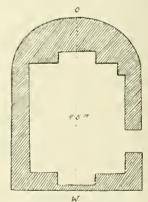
Grundriss einer Kapelle bei Sarikawak.
